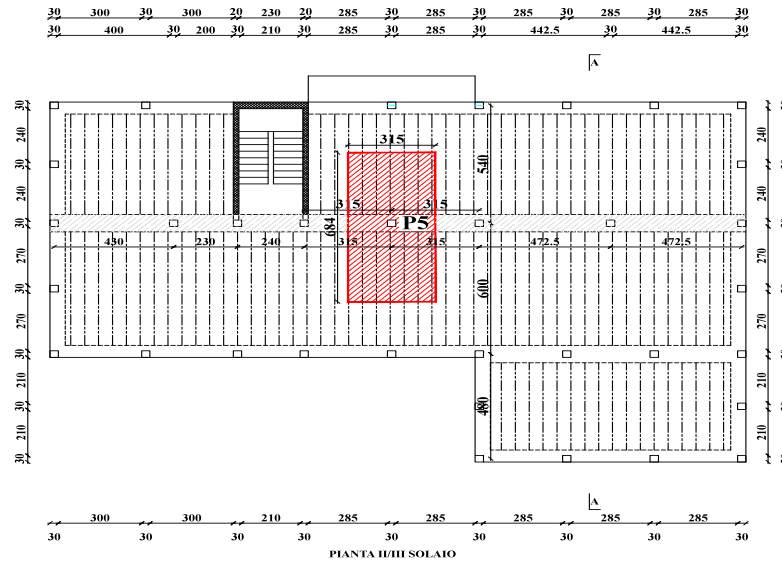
Pianta piano tipo – pilastro P5 (misure in cm)
